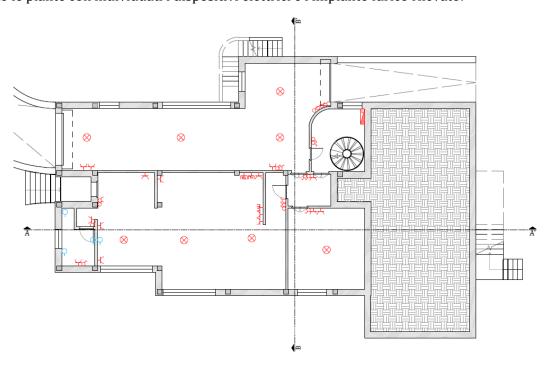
Piano Seminterrato con indicazione dei dispositivi rilevati.
